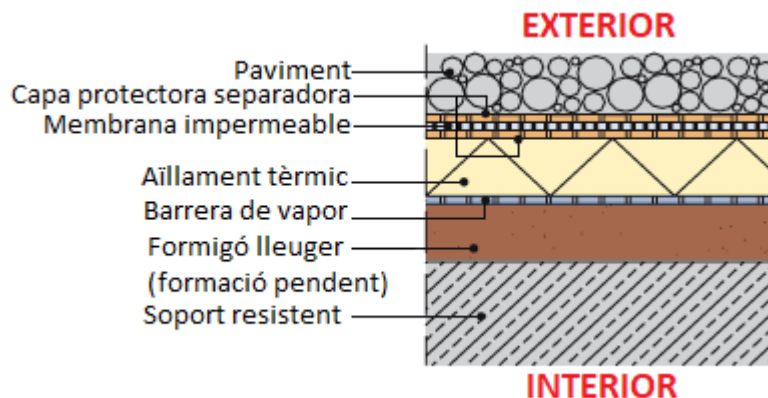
Capes coberta plana tradicional. (Font: "Cubiertas Estévez" [11])
